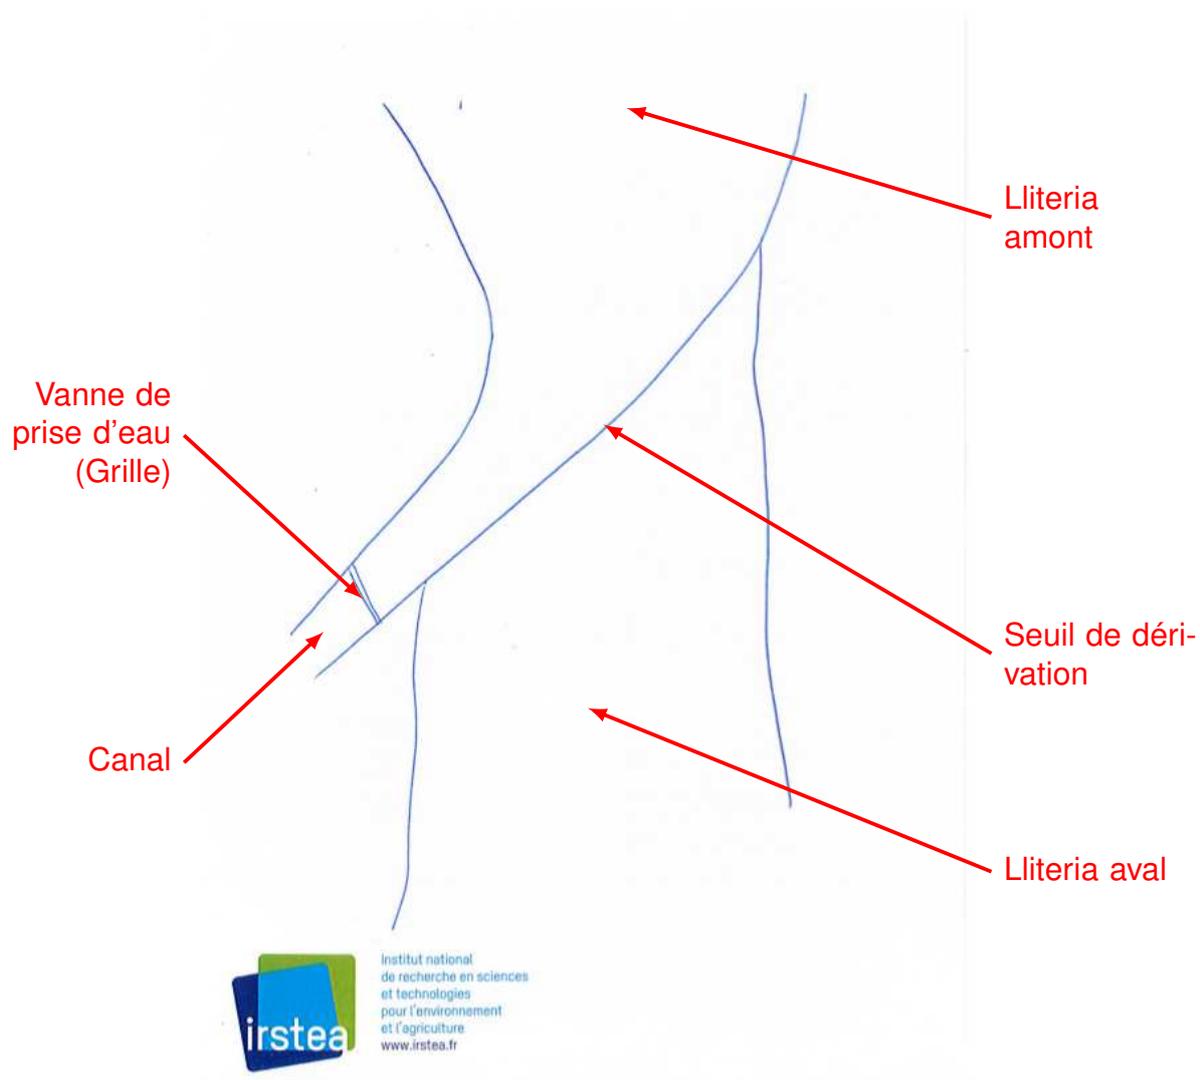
Plan de la prise d'eau Canal de la Illetterà ©IGN
